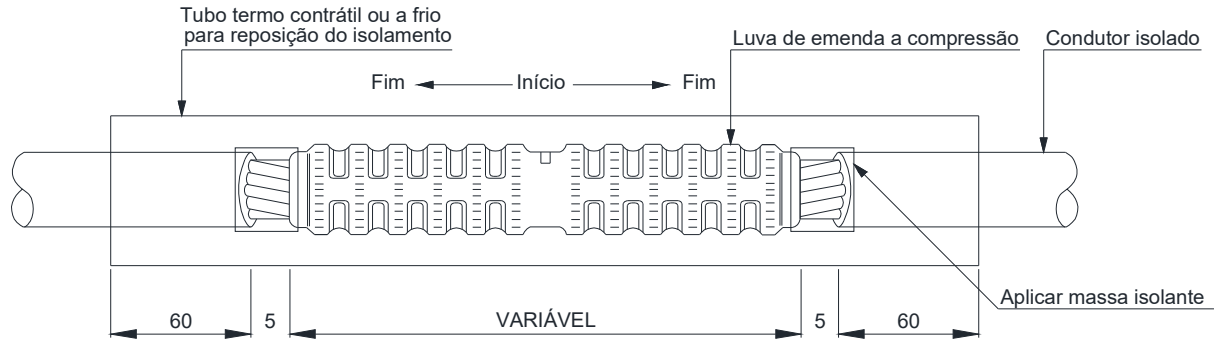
Conexões e emendas – Emenda de cabo de alumínio protegido – Construção
